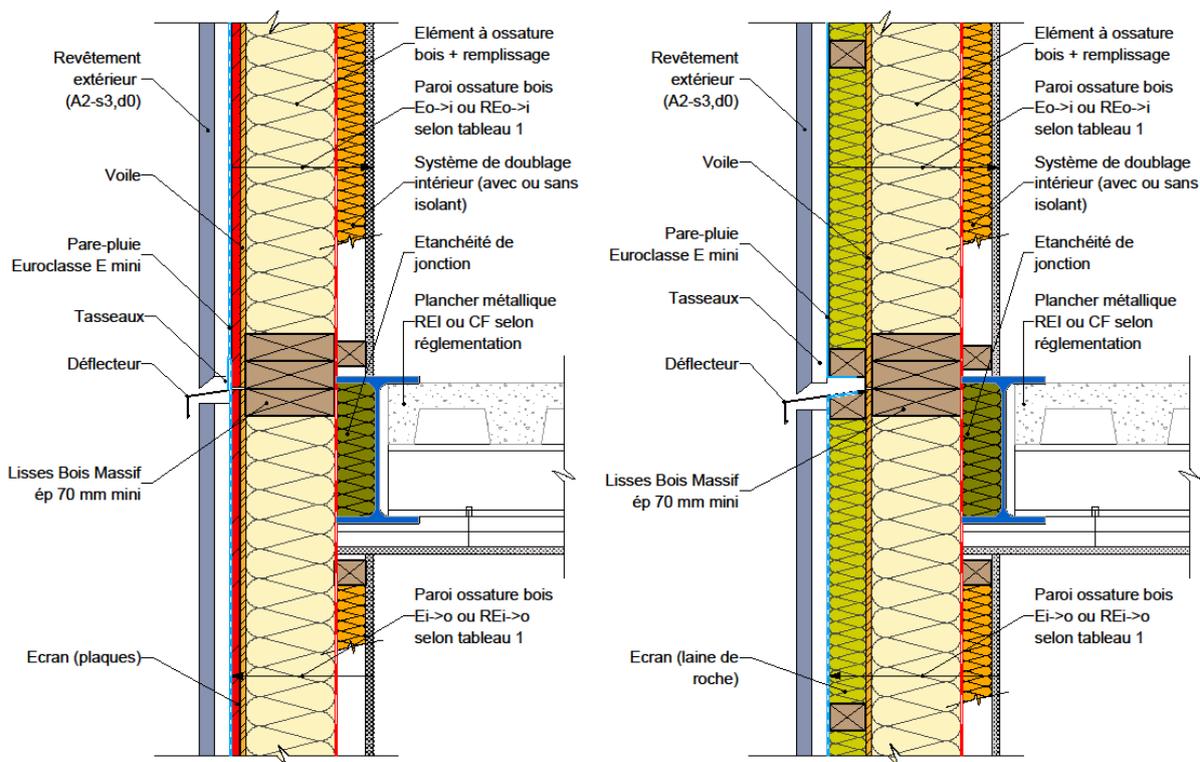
Façade/mur en ossature bois & plancher métallique.
